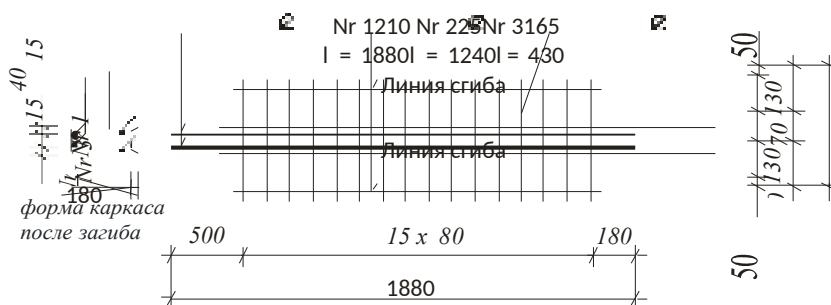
Дополнительный арматурный каркас, используемый в зоне опоры балок перекрытия «TERIVA NOVA» на стену, находящиеся на разных уровнях.
